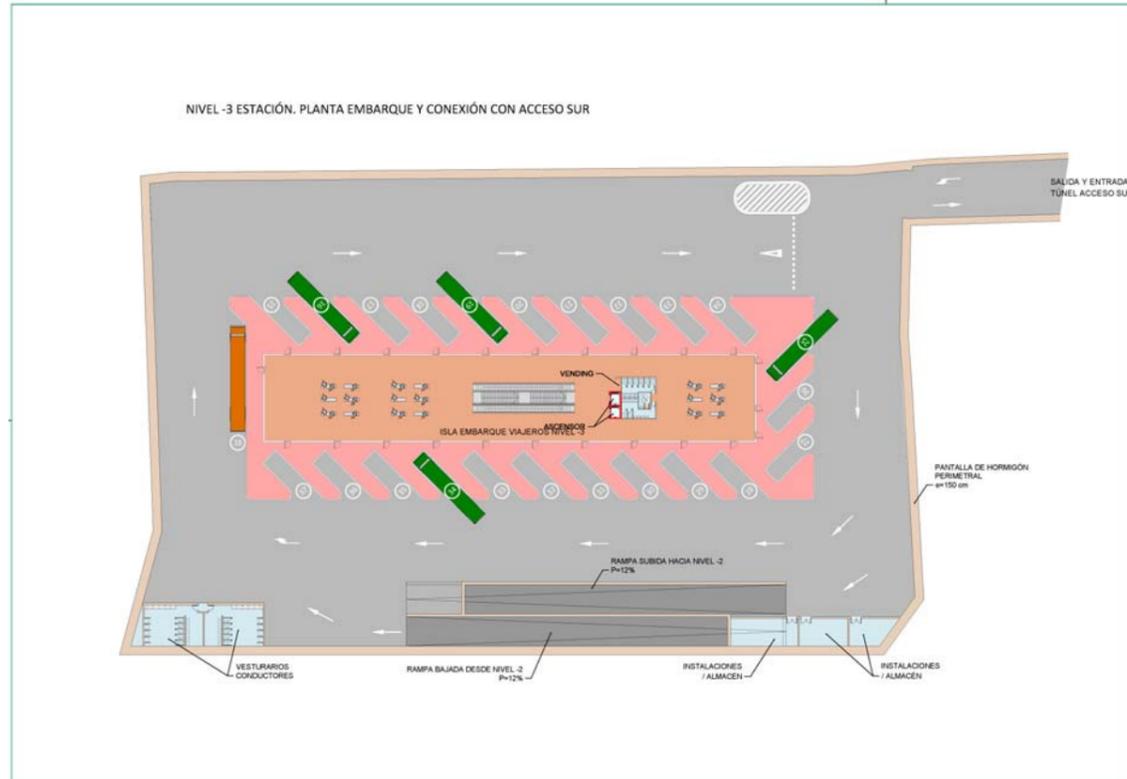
Alternativa-2. Planta -3 (Planta -2 de operativa de autobuses).
